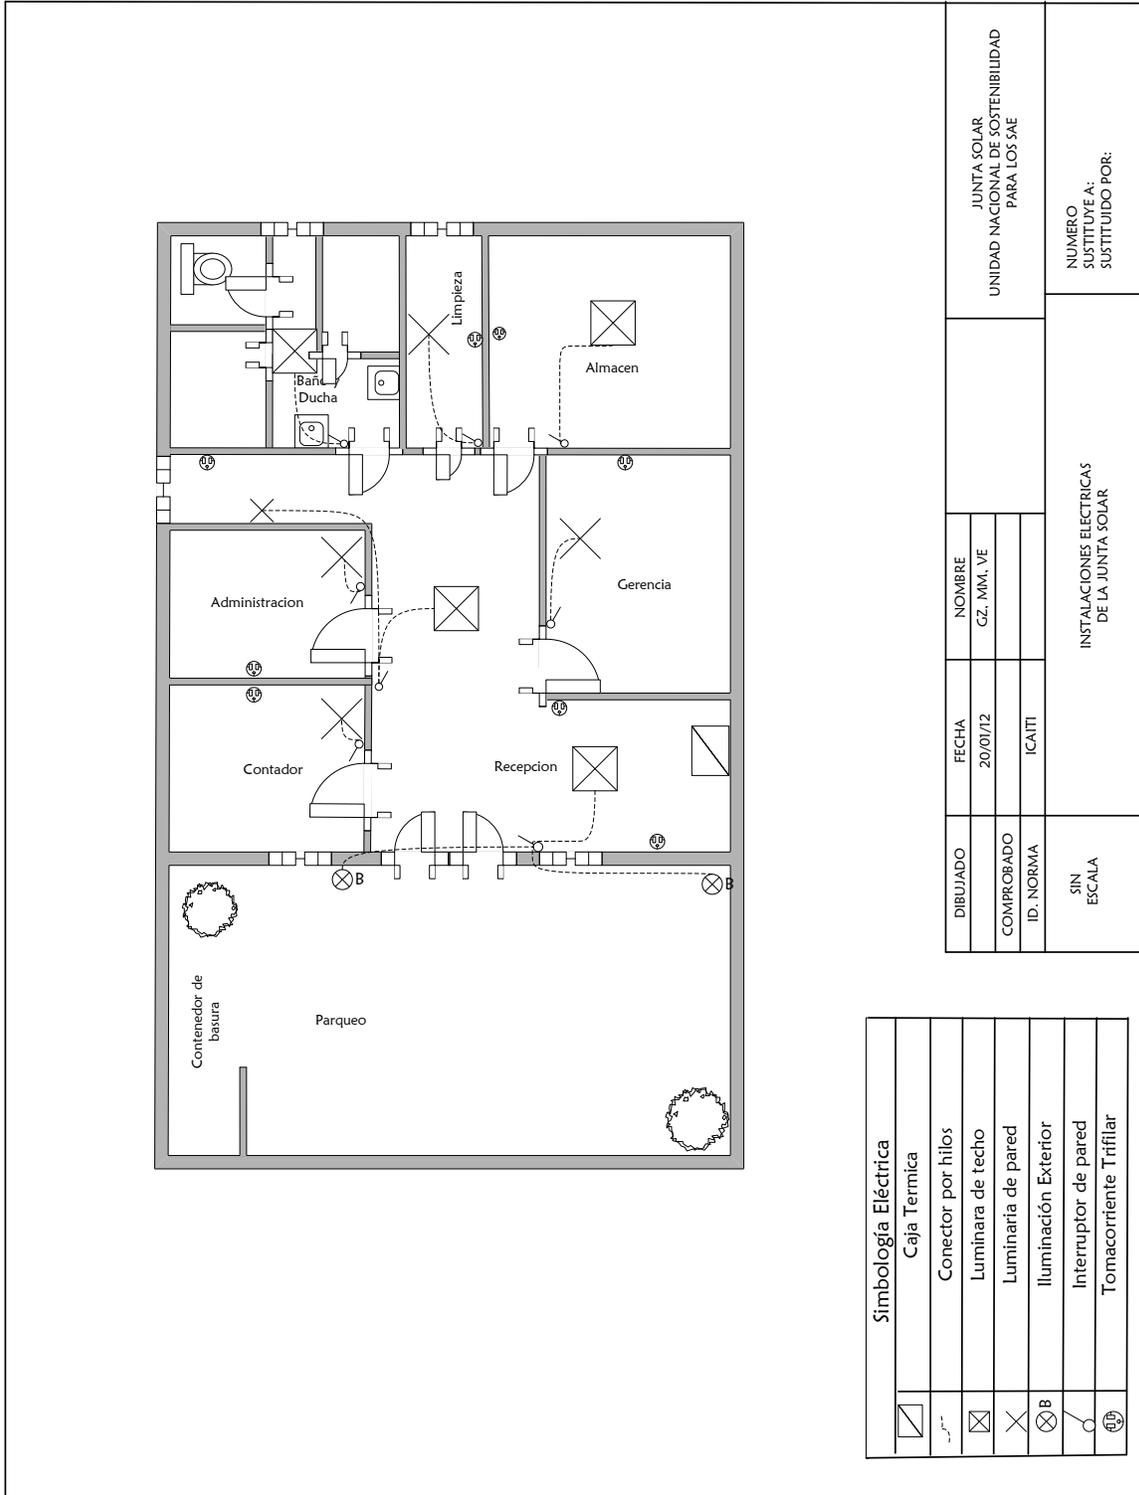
Distribucion en planta de la Junta Solar – Instalaciones Electricas
